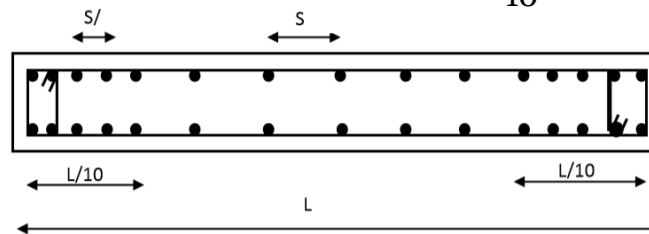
Disposition des armatures verticales dans les voiles.
